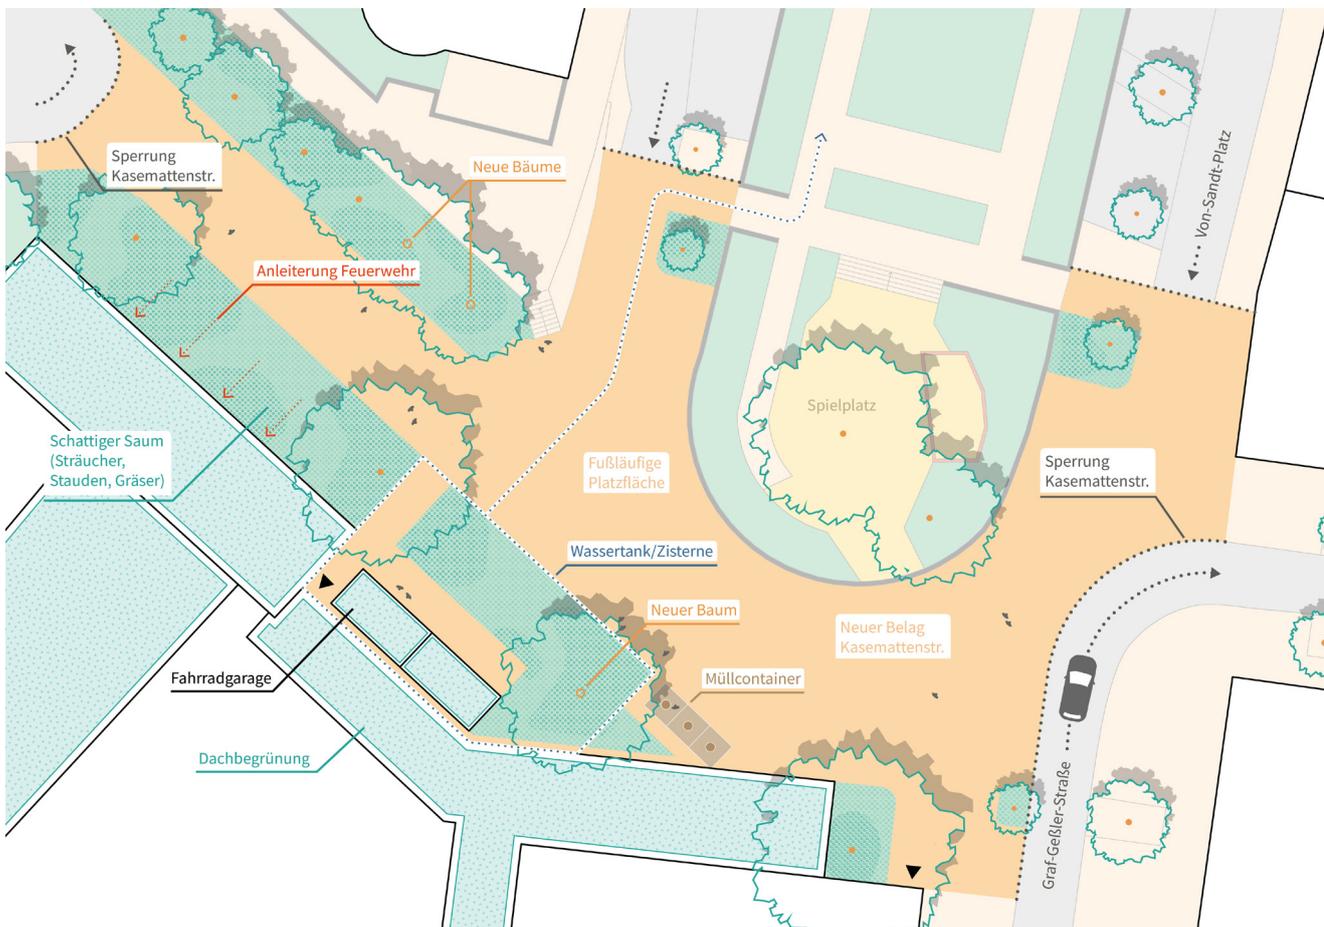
Vorschlag 2 – Grundriss Gesamtsituation
